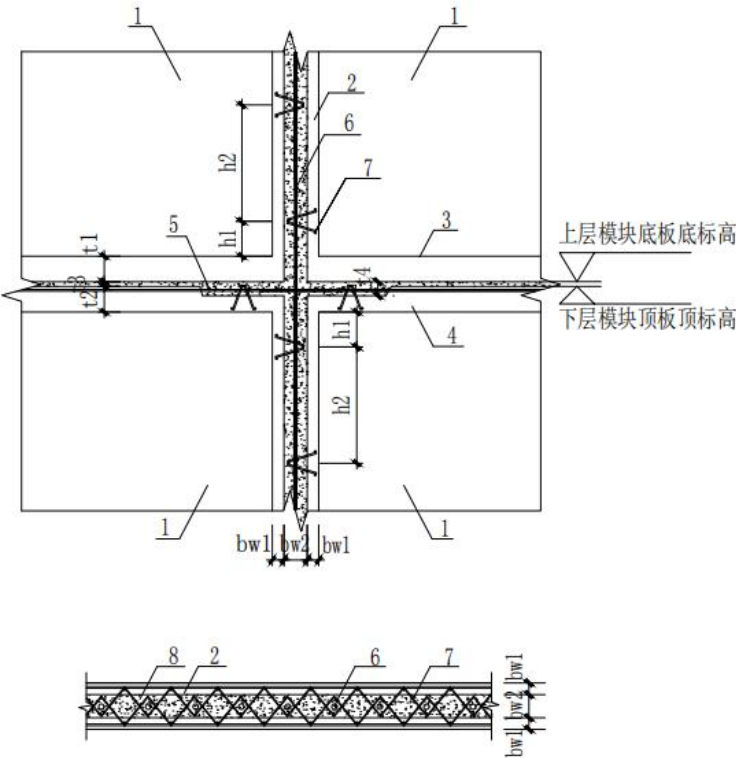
桁架筋叠合混凝土模块剪力墙水平连接构造示意图
